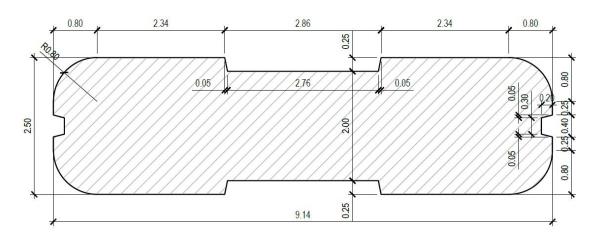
Vista Tipica dall'alto e Sezione Tipica sotto pulvino (uguale per tutte le pile). a
